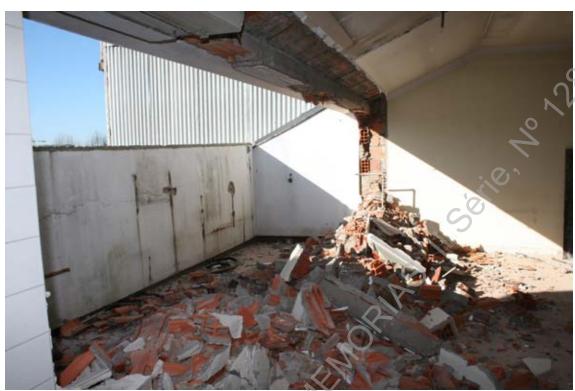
(IMG\_5582) – Pormenor do acompanhamento da demolicação de parede interna do edifício localizado na Avenida Central n.ºs 157-163, Braga.
